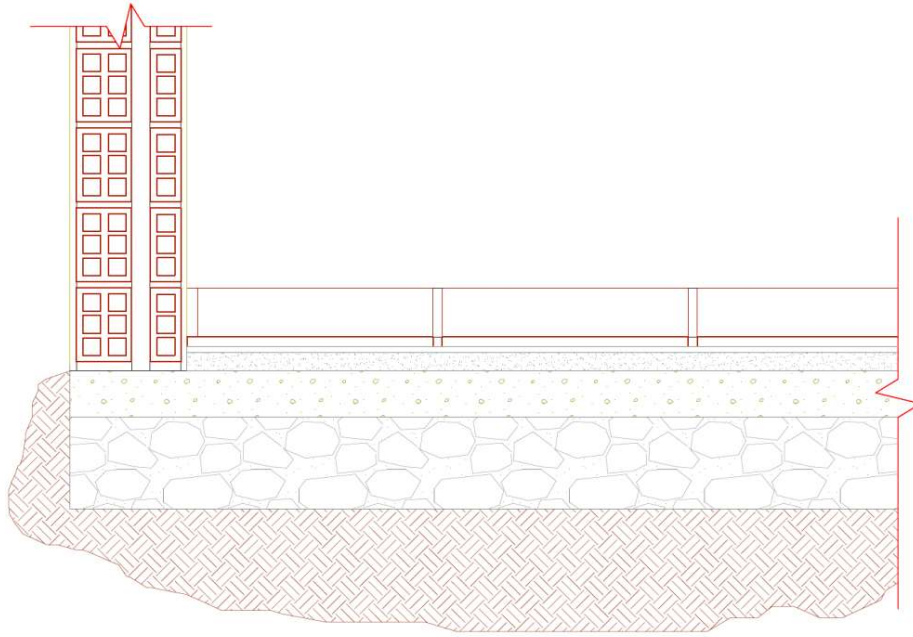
Sección suelo en contacto con el terreno, (Fuente: CAD/autor). * ver plano nº 10
